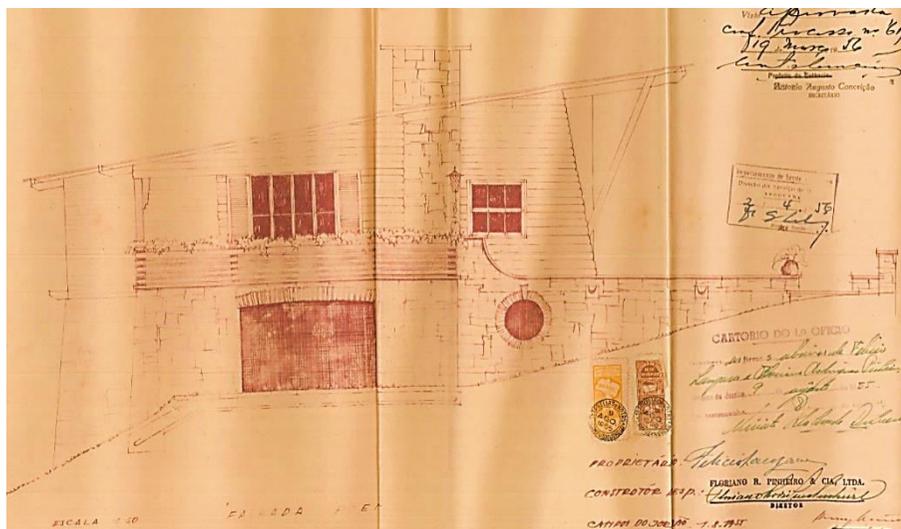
Face oeste na ampliação de 1955, com terraço em primeiro plano.
